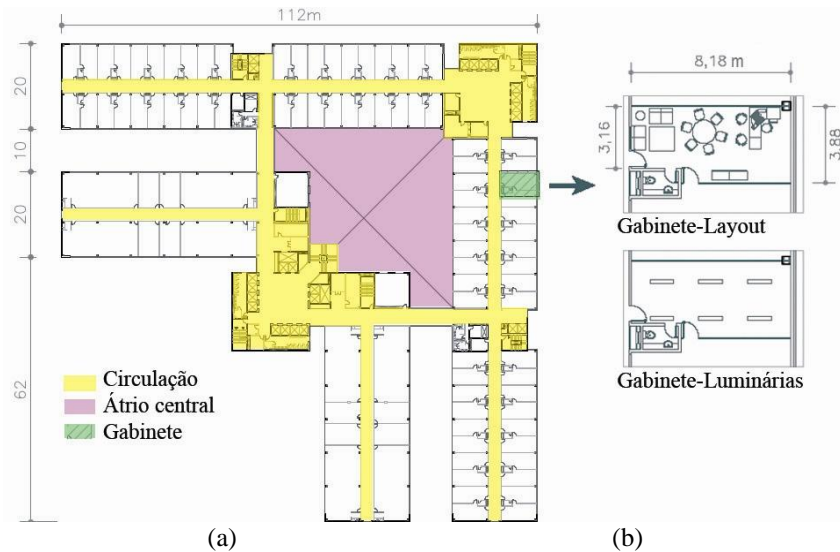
Plantas do pavimento-tipo e do ambiente em análise: (a) Planta do pavimento-tipo e a localização do ambiente em estudo; (b) Planta do ambiente-tipo em análise com layout e distribuição das luminárias.
